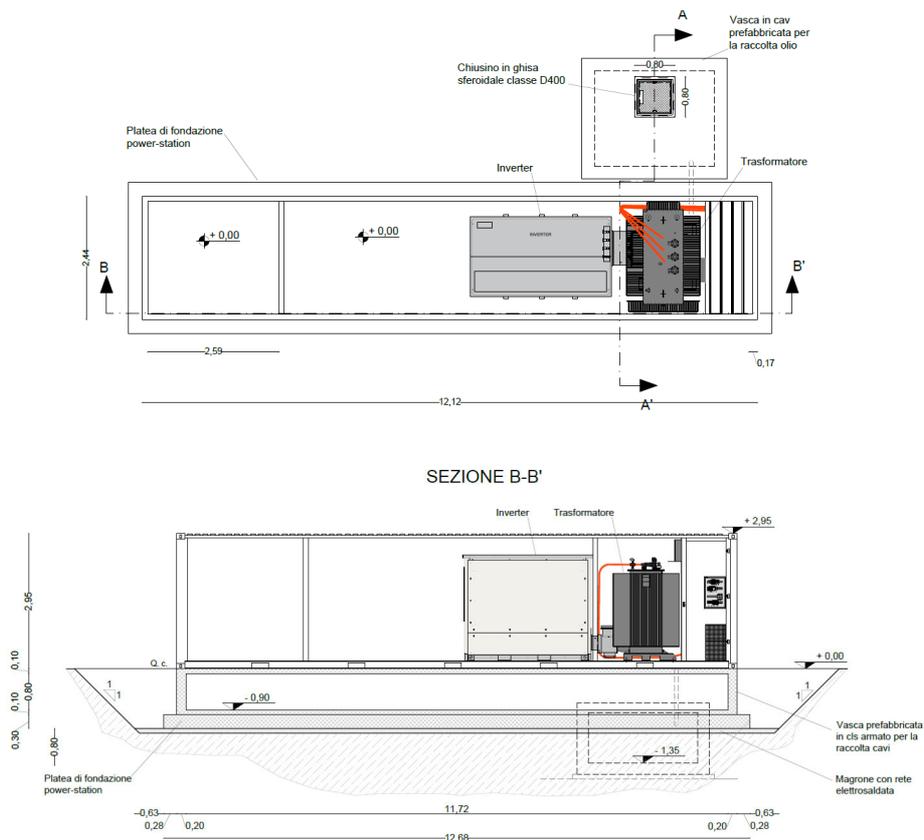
Schema costruttivo in pianta e sezione di una Power Station tipo in progetto
